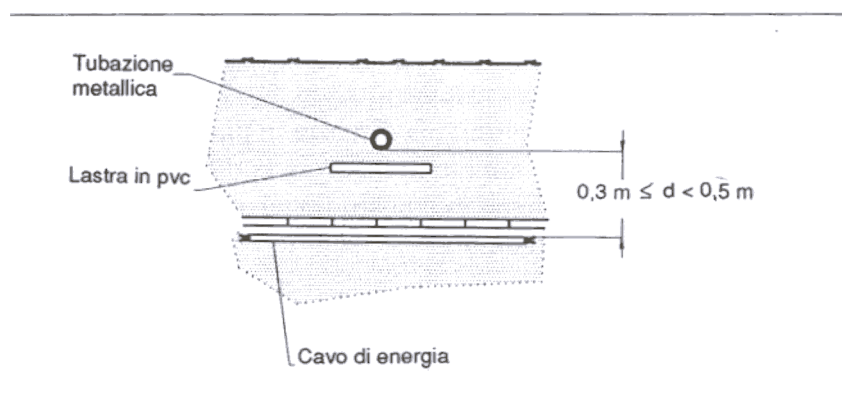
Se il cavo di energia dista dalla tubazione metallica meno di 0,5 m, occorre un elemento separatore non metallico.
